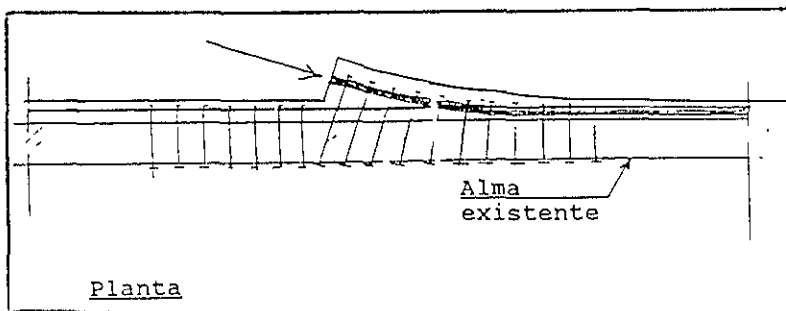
Presfuerzo Adicional; anclaje intermedio (sección horizontal).
